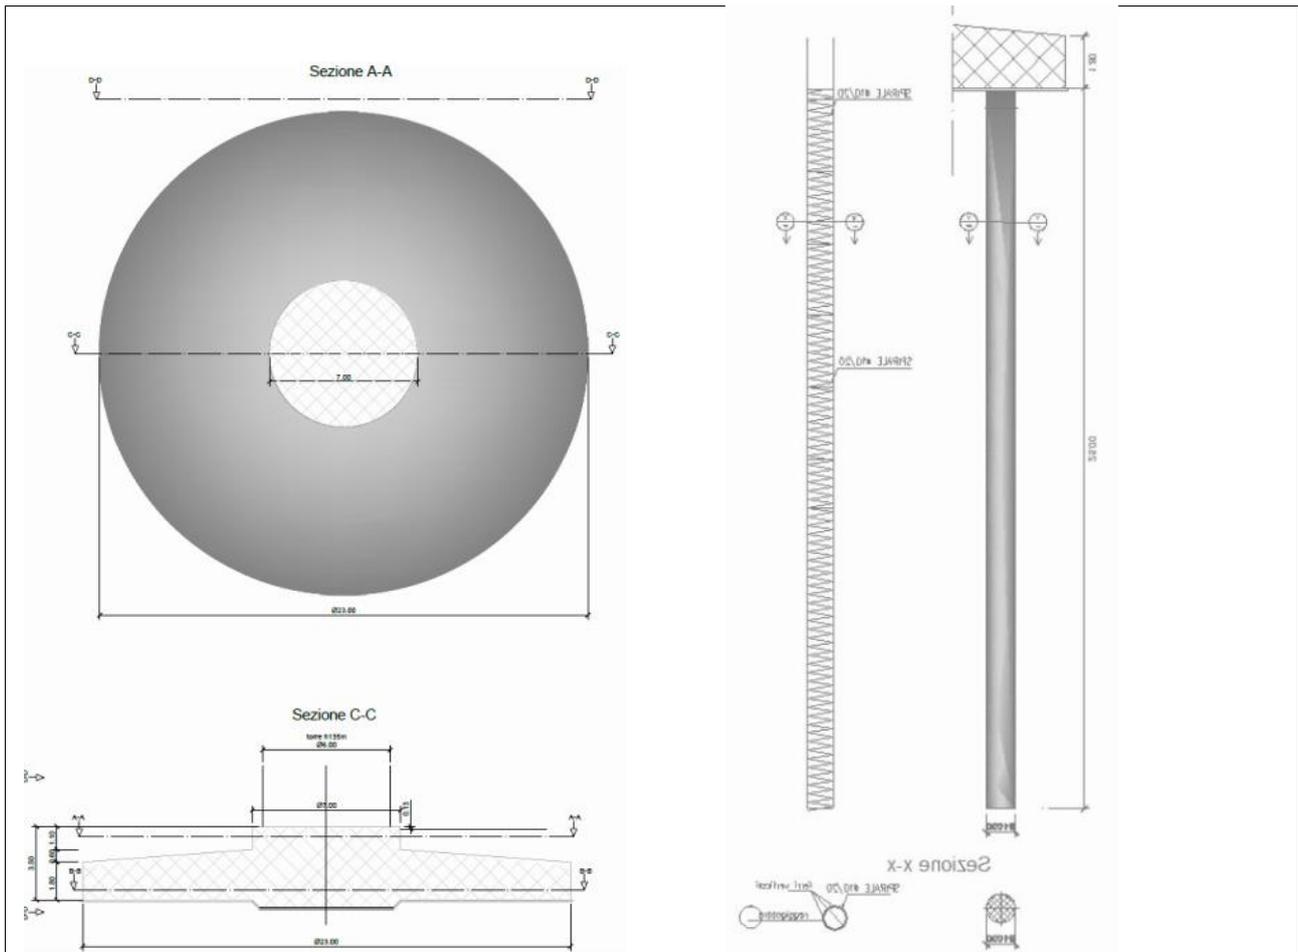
Pianta e sezione tipologica fondazione (immagine a sinistra) e tipologica delle fondazioni profonde (immagine a destra)
